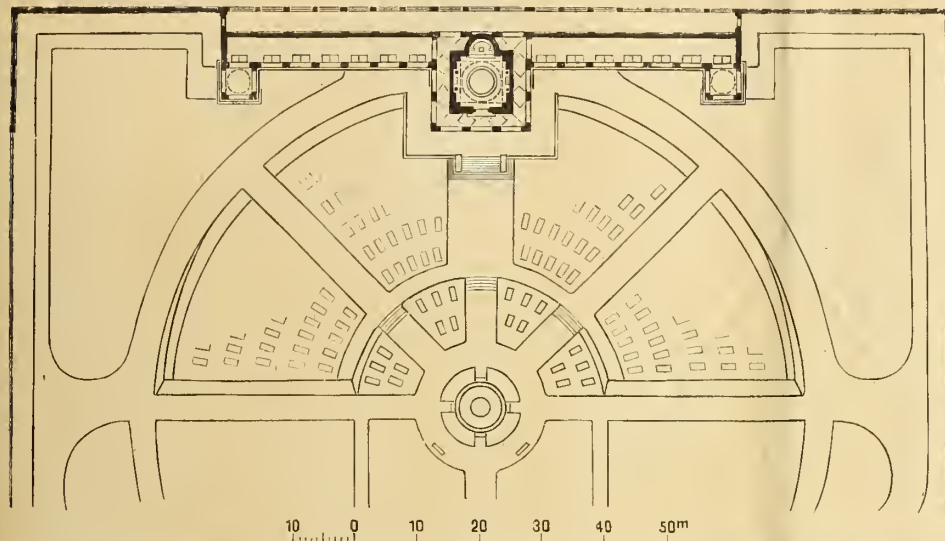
Lageplan und Grundriß des Mausoleums mit der Arkadengruftanlage.
